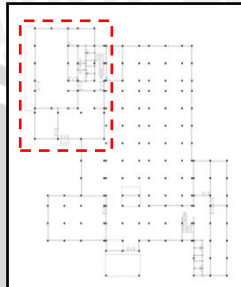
Denah Ortogonal Layanan Perpustakaan Anak Lantai 2
